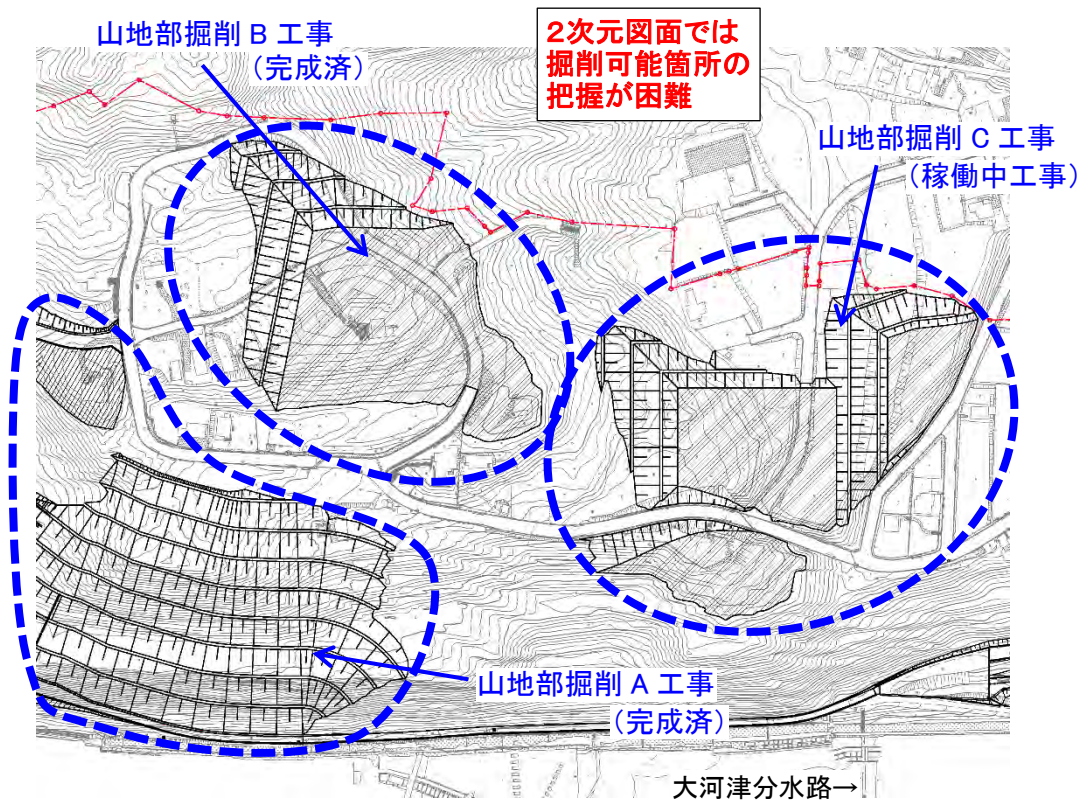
(5)-2 掘削箇所の検討平面図 (2次元図面の場合)
